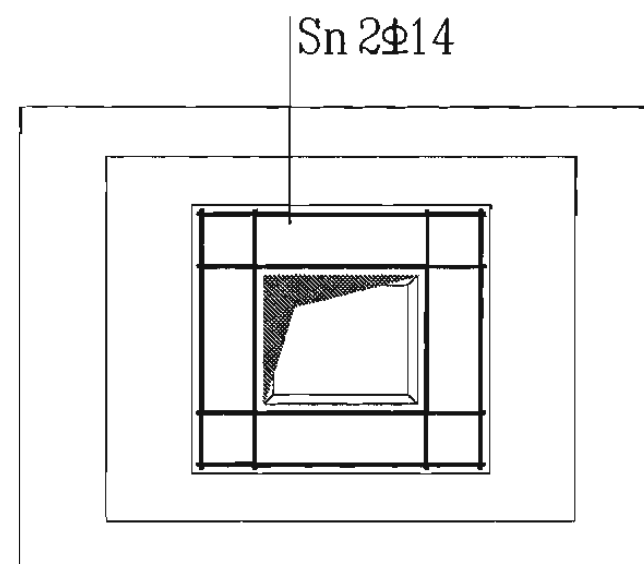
单杯口独立基础顶部焊接钢筋网示意
